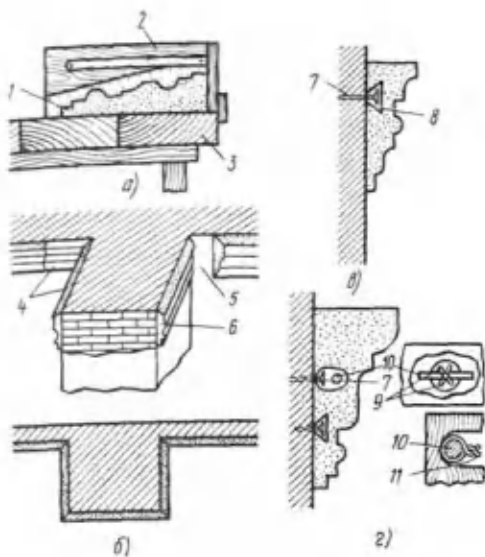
Установка сборных углов и раскреповок: а - вытягивание тяги на верстаке, б — установка, в — крепление на гвоздях, г — крепление проволокой; 1, 4 — тяги, 2 — шаблон, 3 — верстак, 5 — место для тяги, 6 — раскреповка, 7 — гвоздь, 8 — паз, 9, 11 — проволока, 10 — штырь
